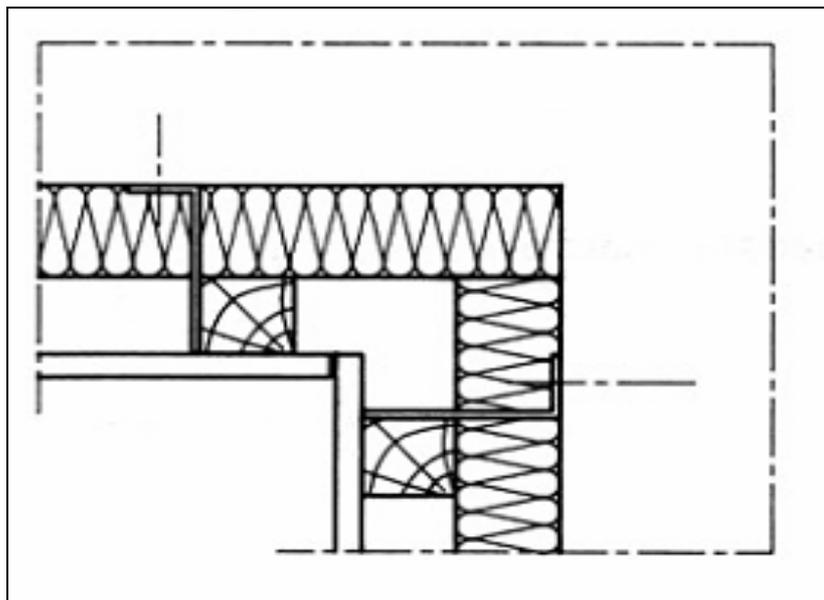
Solución a unión en 90° del sistema de aislación de fachada ventilada.
